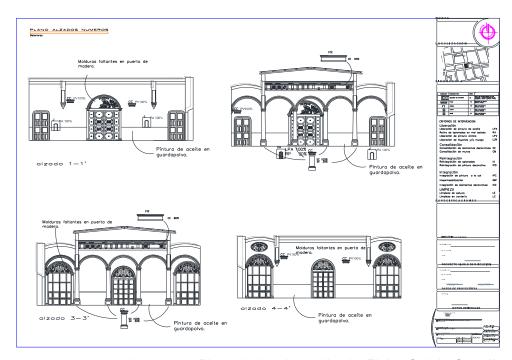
Plano de deterioros Alzado. Eloísa Galván González. 2016.
